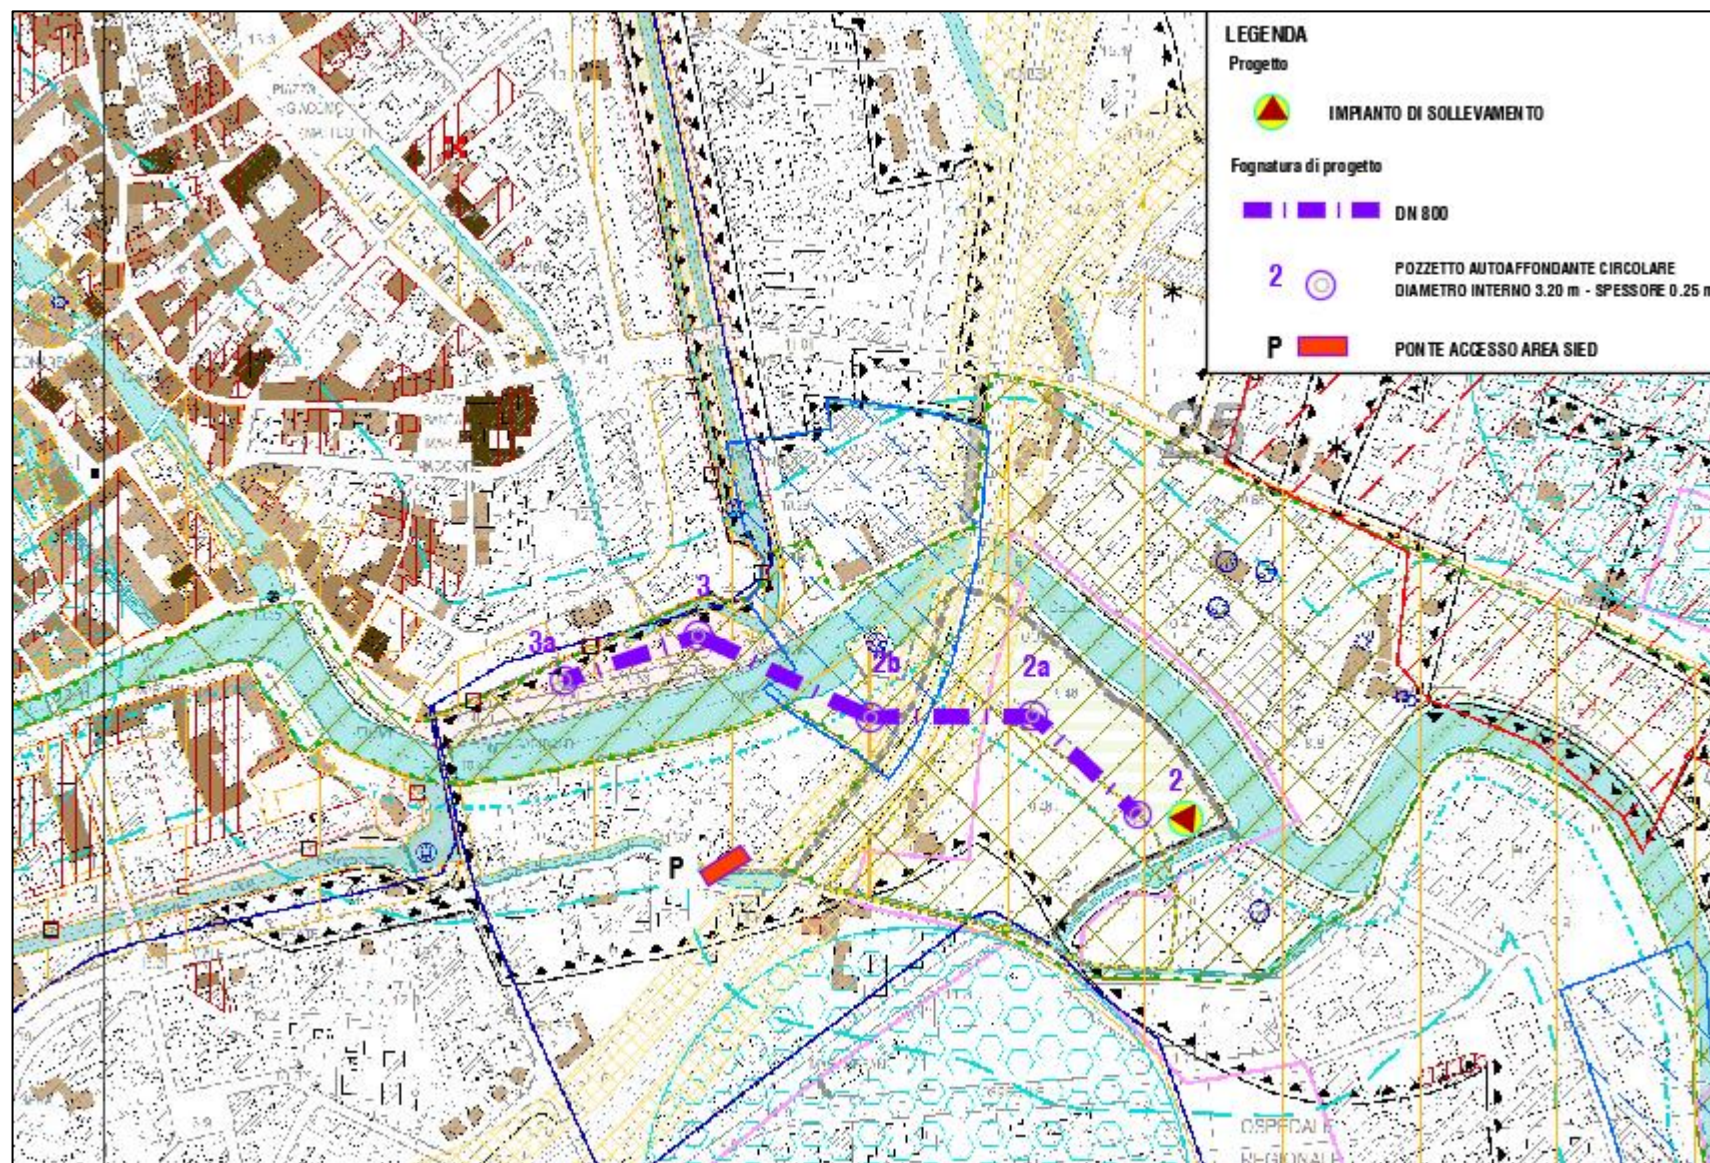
E : Estratto planimetrico – P.I. TAV. T05 – VINCOLI E SERVITU'
